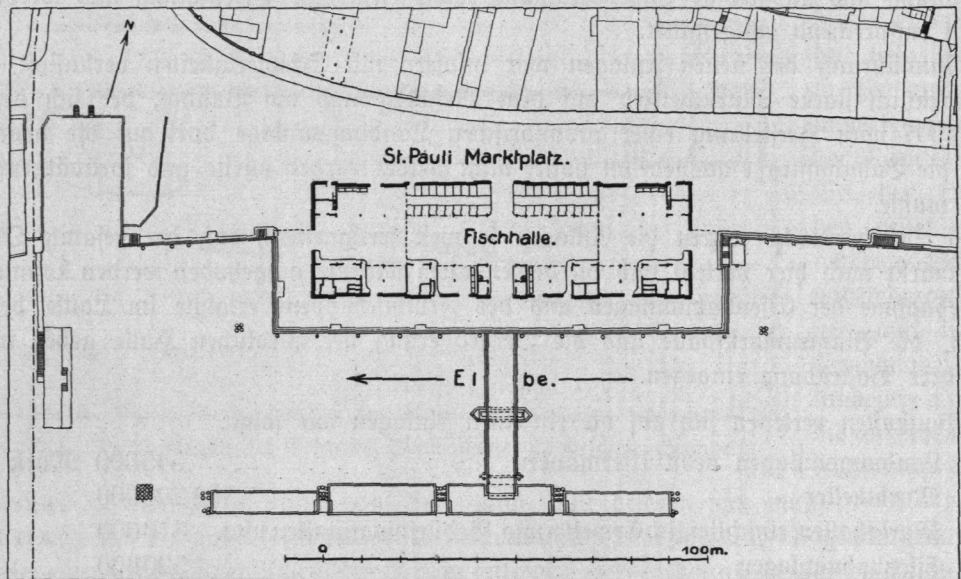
St.-Pauli-Fischmarkt, Lageplan und Hallengrundriß.
